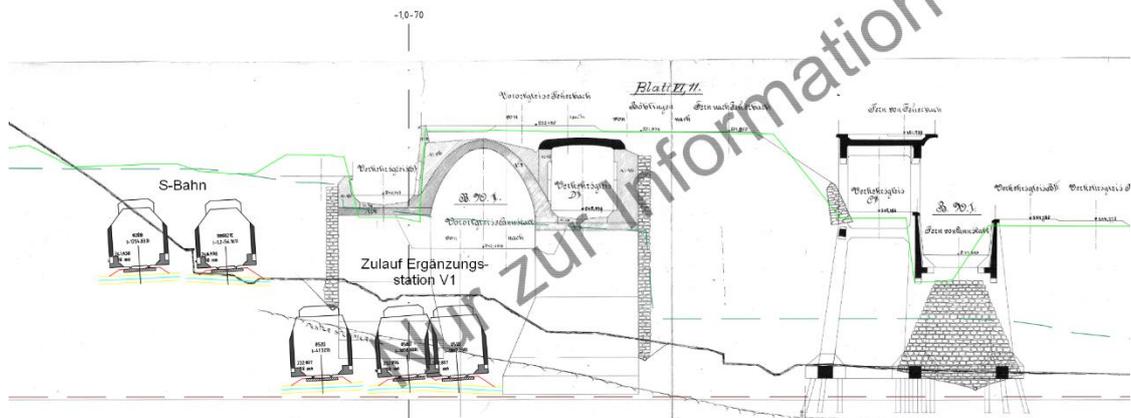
Überlagerung Bestandsbauwerk mit Planung bei km -1,0-70, Blickrichtung Nordosten
